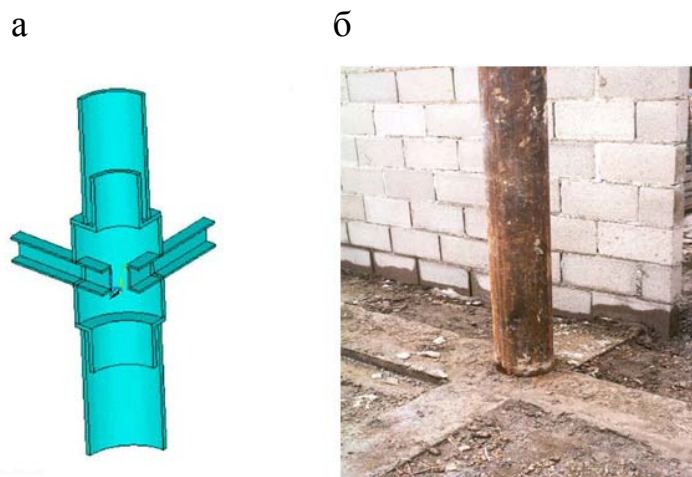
Элемент узла сопряжения трубобетонной колонны с перекрытием (а), вид узла сопряжения в строящемся здании (б)
